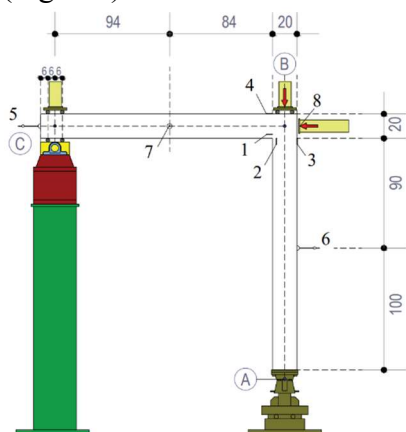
Set-up del telaio in calcestruzzo armato non rinforzato
